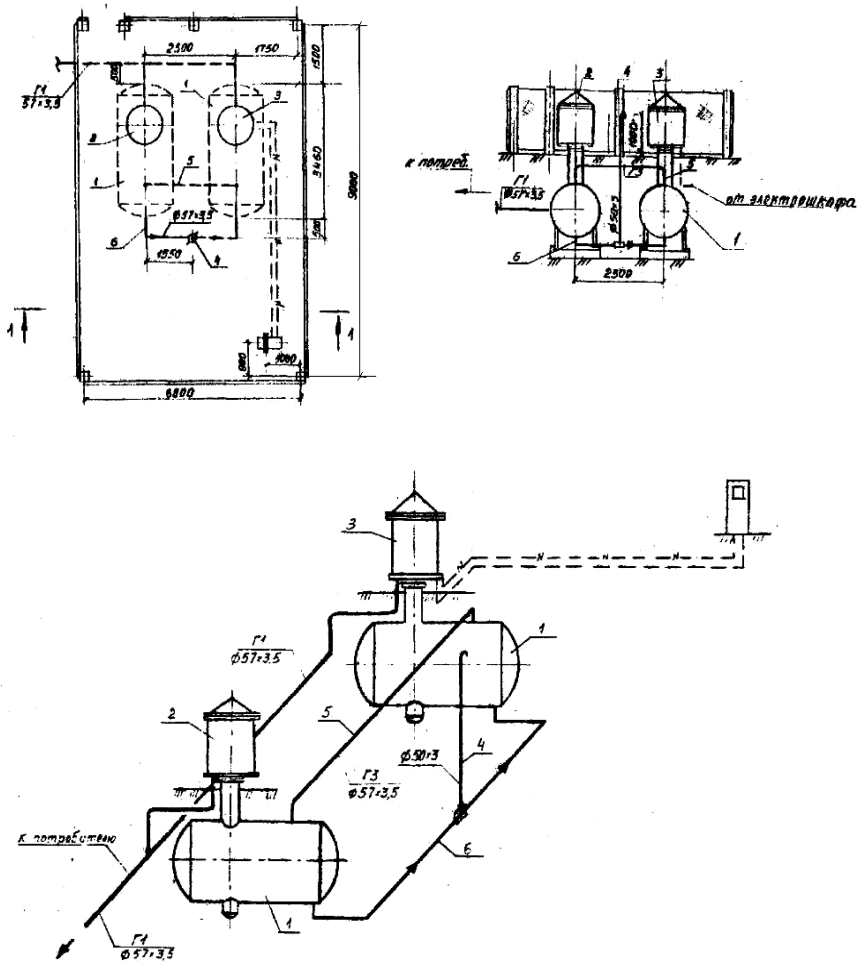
Схема резервуарной установки с испарителем ИЭП-04:
